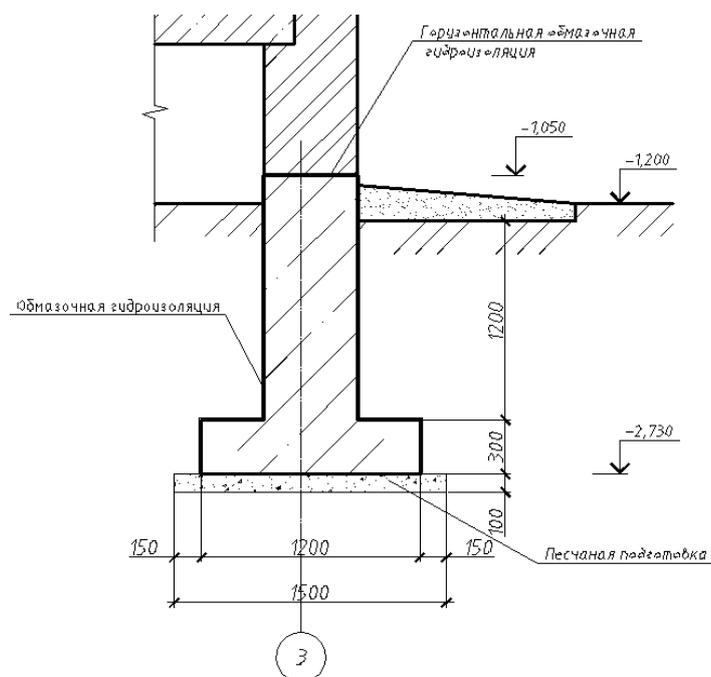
Схема ленточного фундамента под пристраиваемую стену
